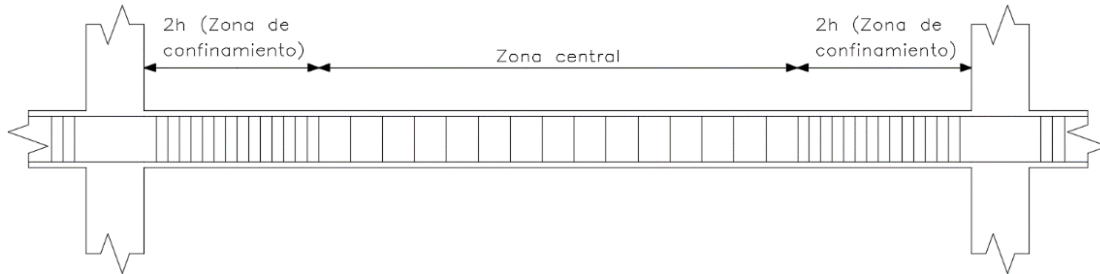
Requerimiento de estribos en vigas – Norma E 0.60
